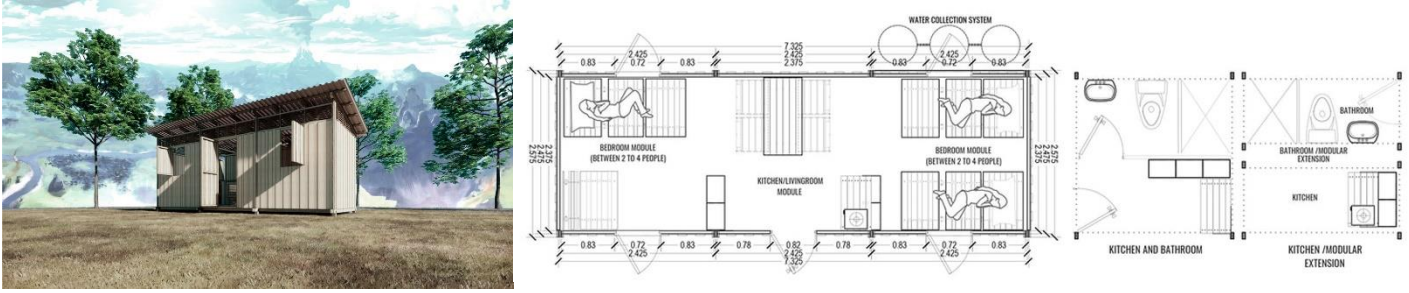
Kokoon ve Plan Şeması (Kokoon, 2016)
